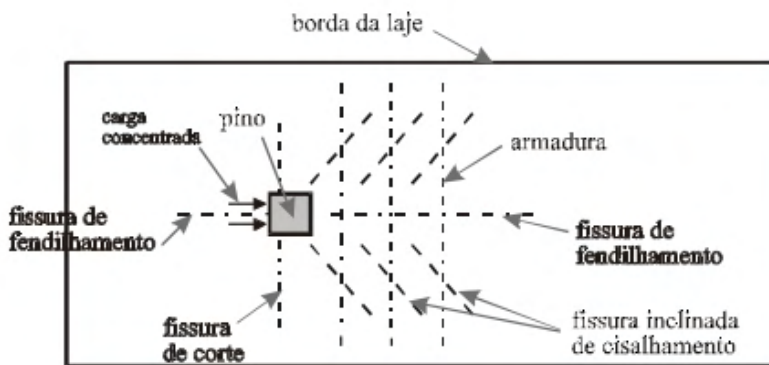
Fissuras de tração induzidas por força concentrada no concreto.
